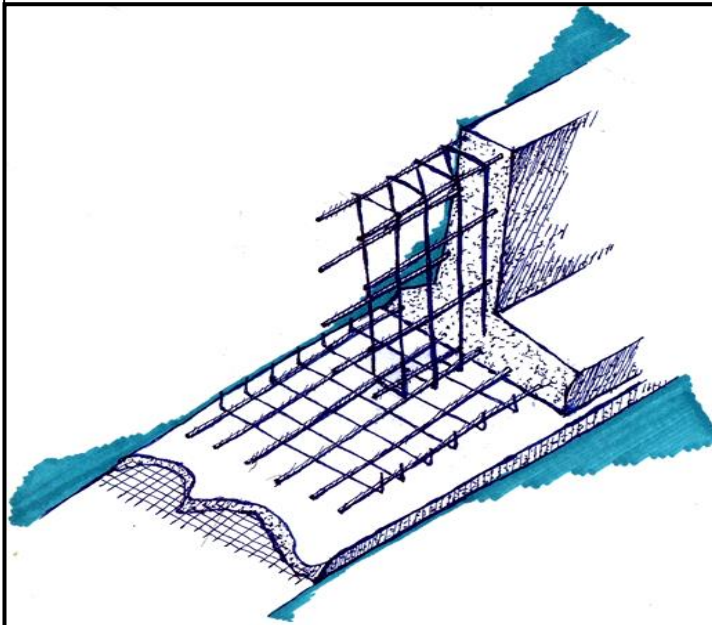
Detalles de la cimentación de zapatas corridas de concreto armado
